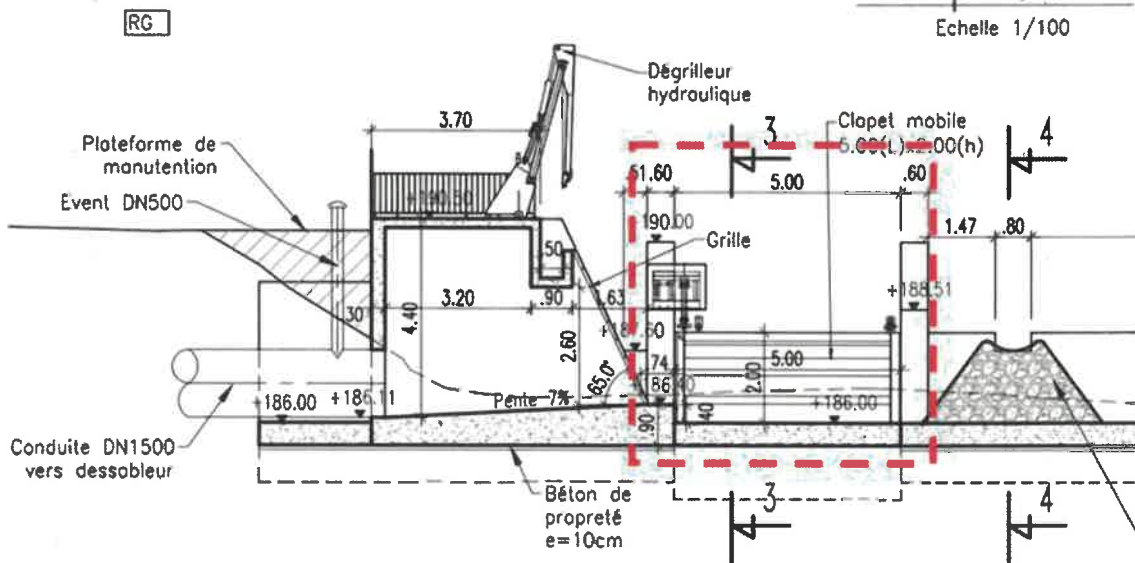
clapet de dégrèvement, coupe sens RD-RG
